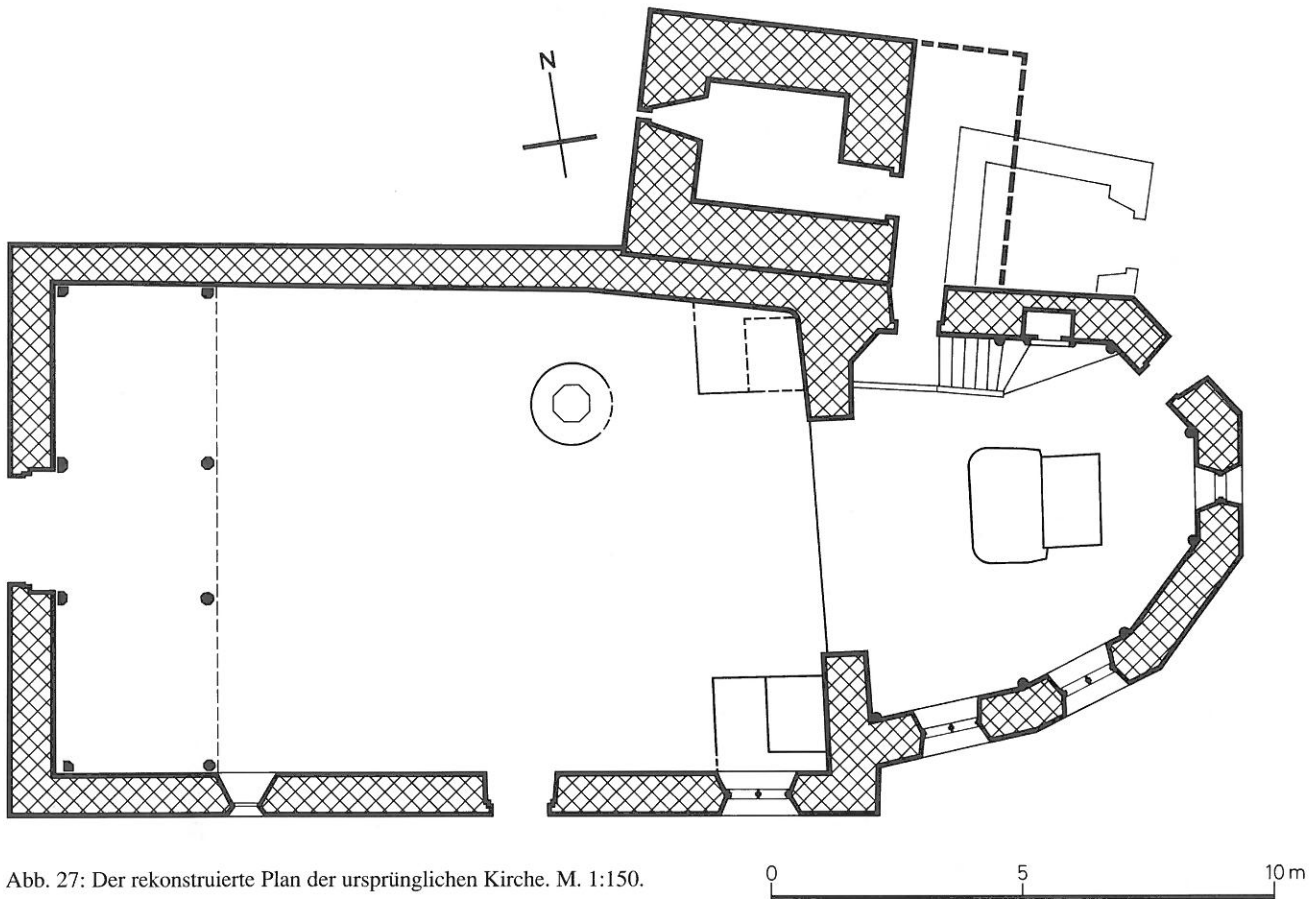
Der rekonstruierte Plan der ursprünglichen Kirche. M. 1:150.
